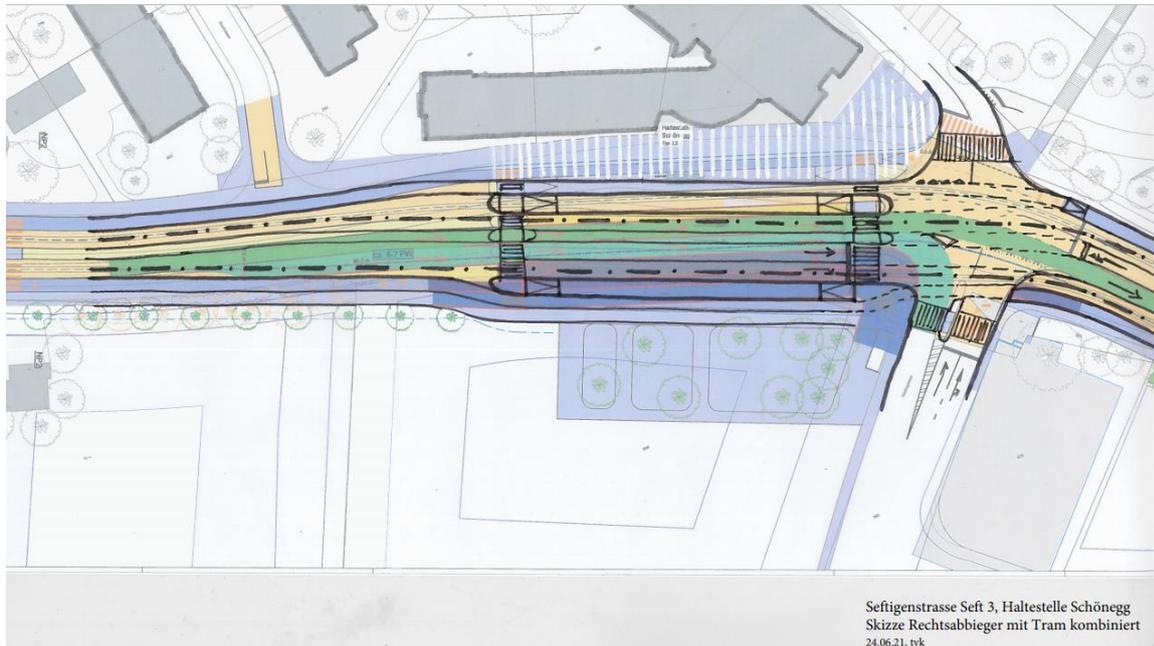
neues Layout mit RA über Tramhaltestelle, gerade Tramführung Richtung Wabern
